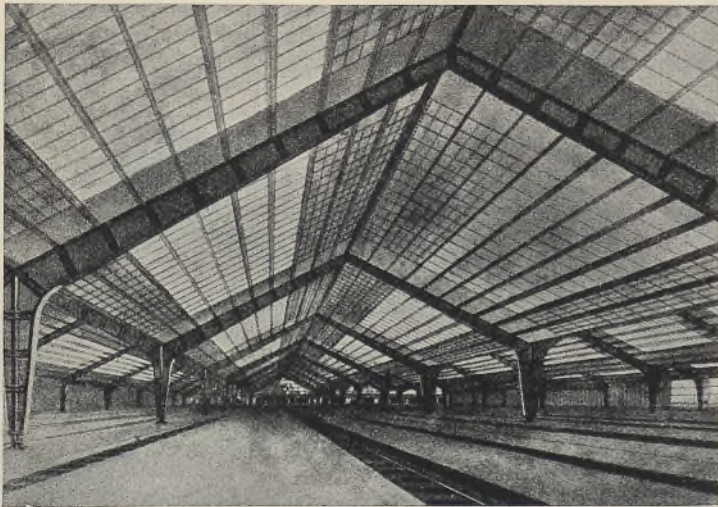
Bahnsteighalle für den Stuttgarter Hauptbahnhof.
